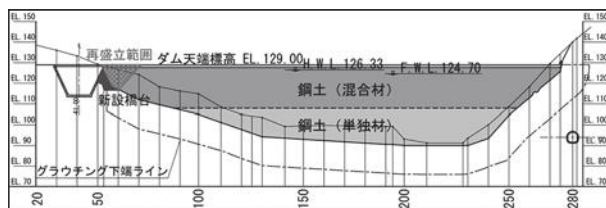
堤体縦断面図(新設橋台・再盛立範囲を明示)
